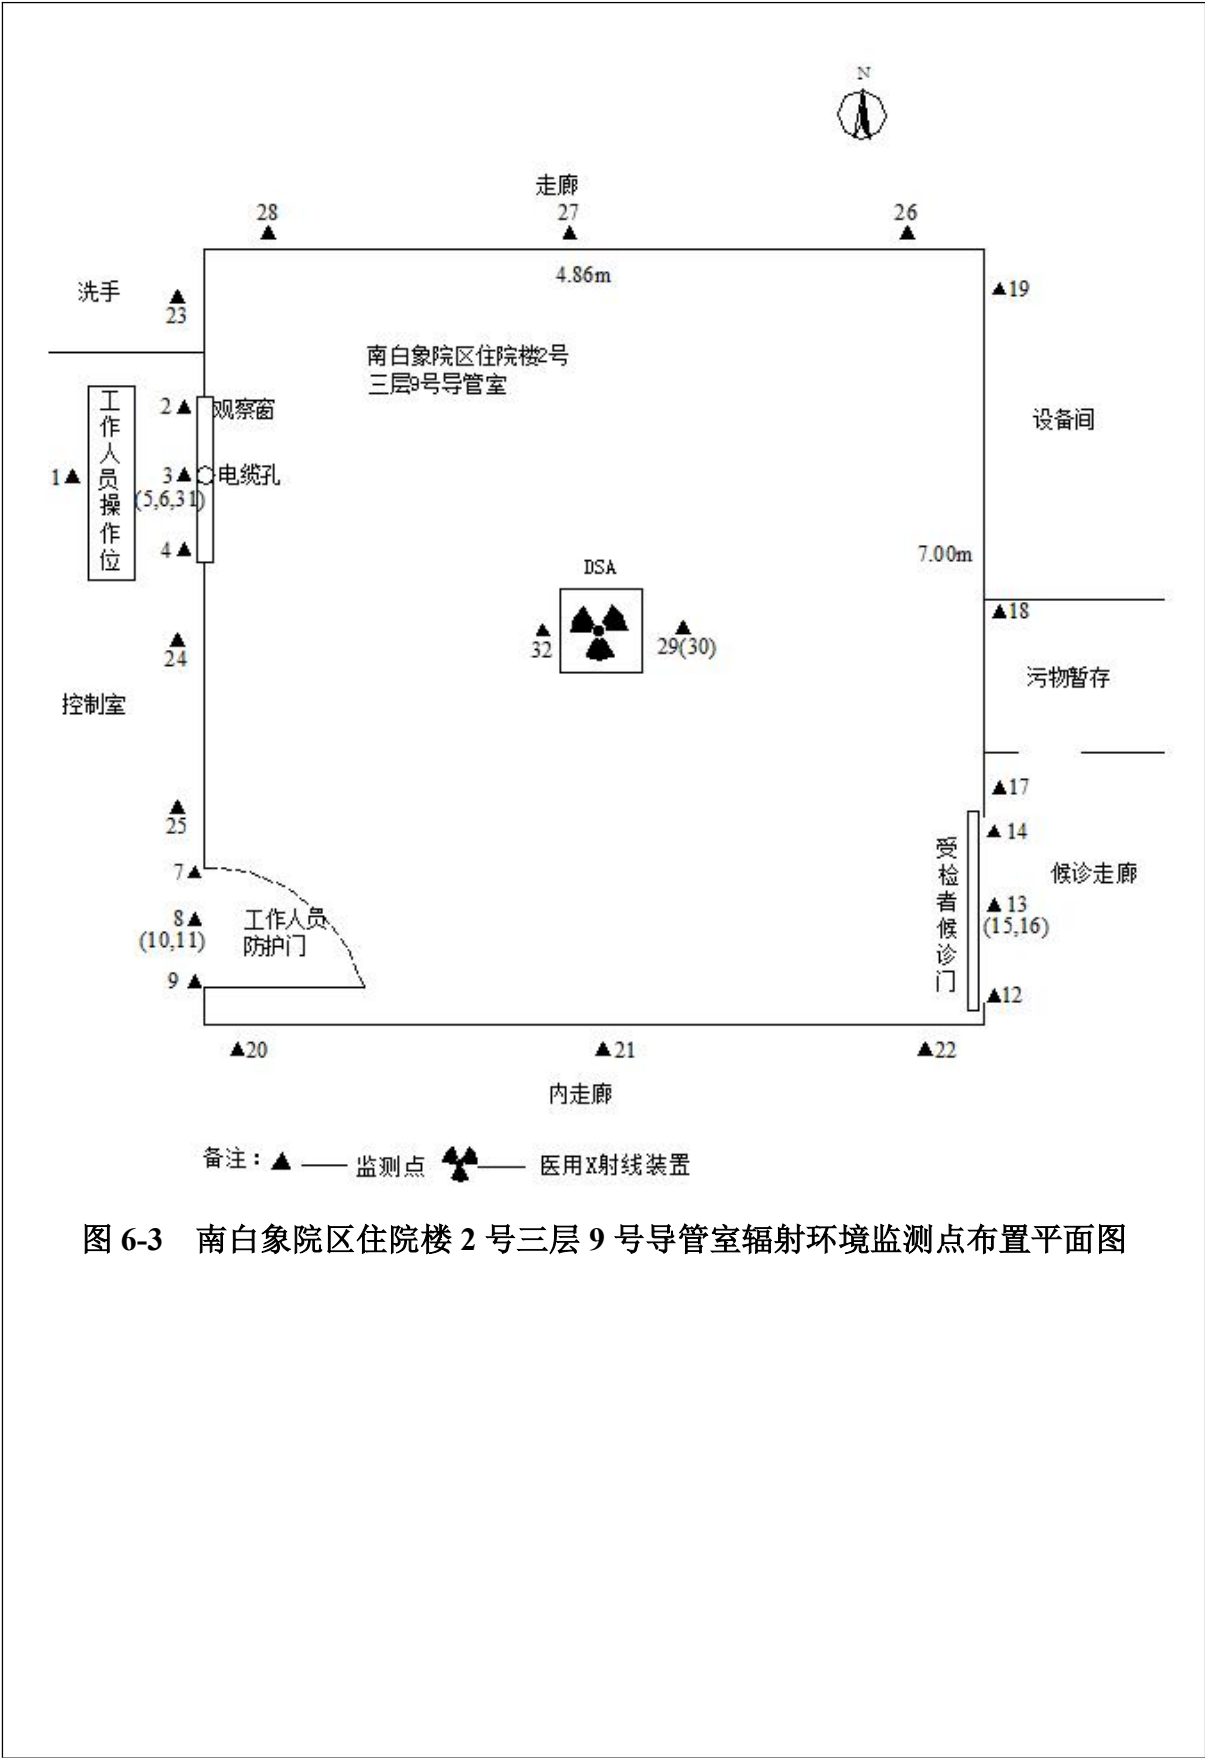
南白象院区住院楼 2 号三层 9 号导管室辐射环境监测点布置平面图
